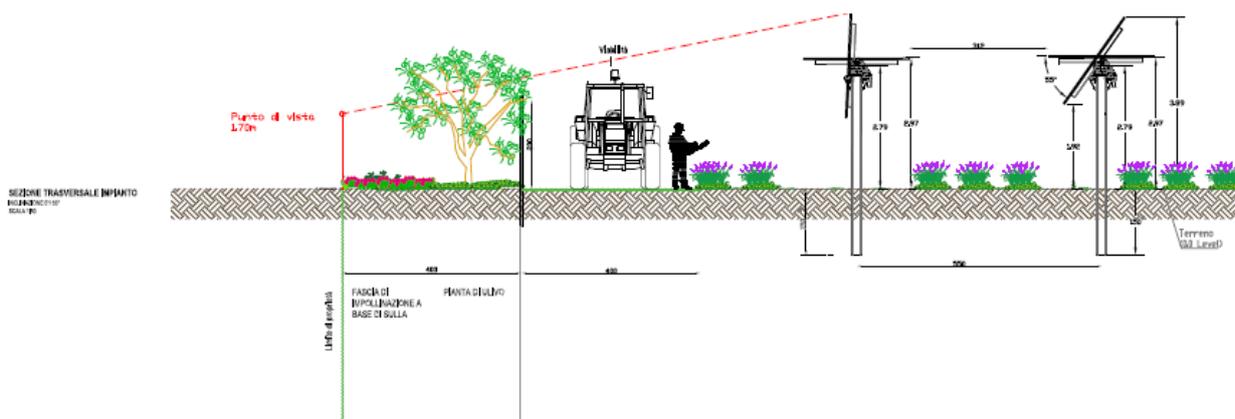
Sezione tipo della soluzione adottata con tracker alto (altezza in corrispondenza dell'asse di rotazione pari a 279 cm) ed interasse di 5,5 m
